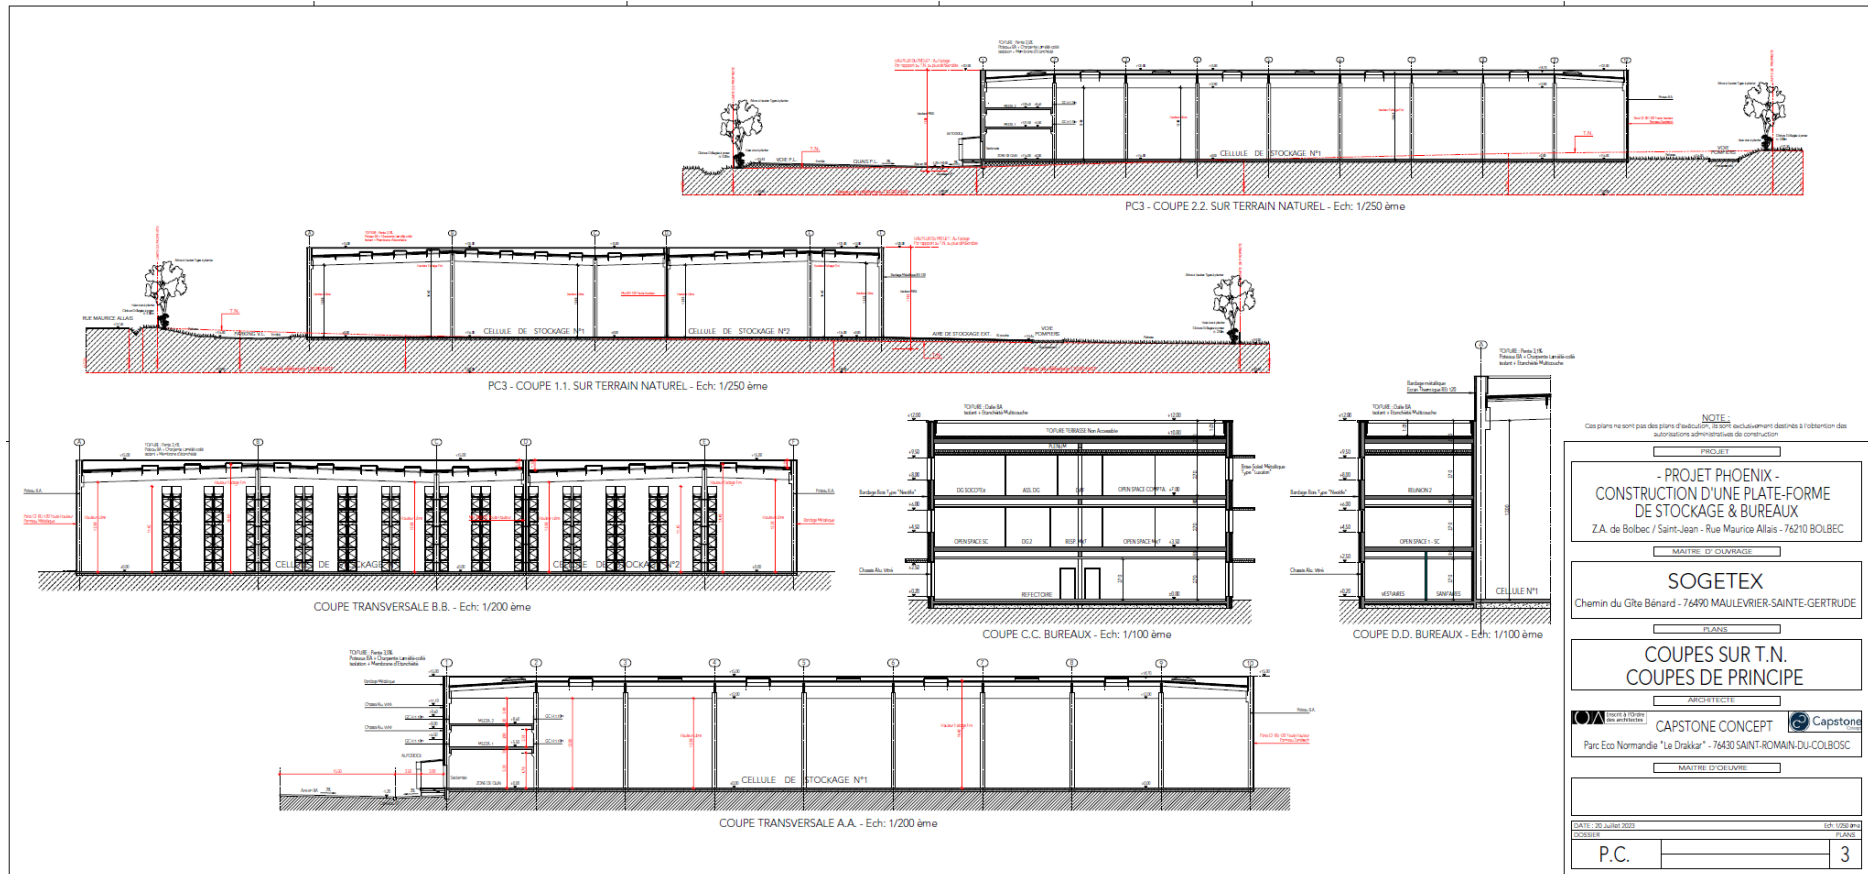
Plan en coupe (source : CAPSTONE CONCEPT)
